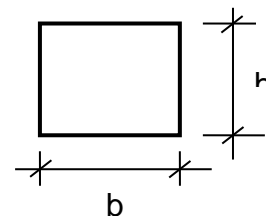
Detalle de losa solida o maciza. Fuente: Elaboración propia.
